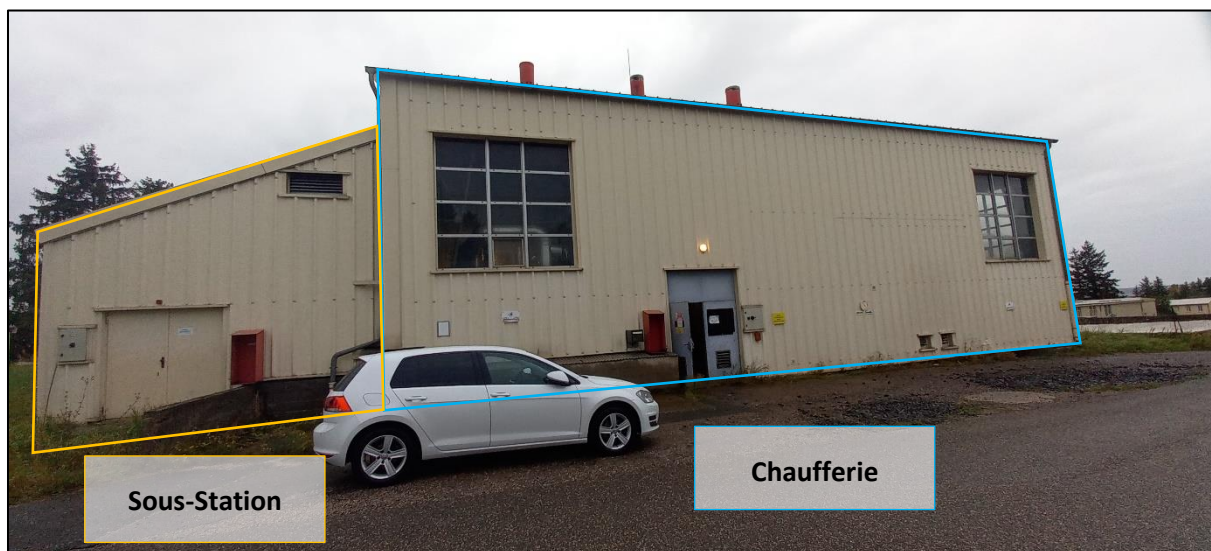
Façade est du bâtiment 0124 - Chauffage.
